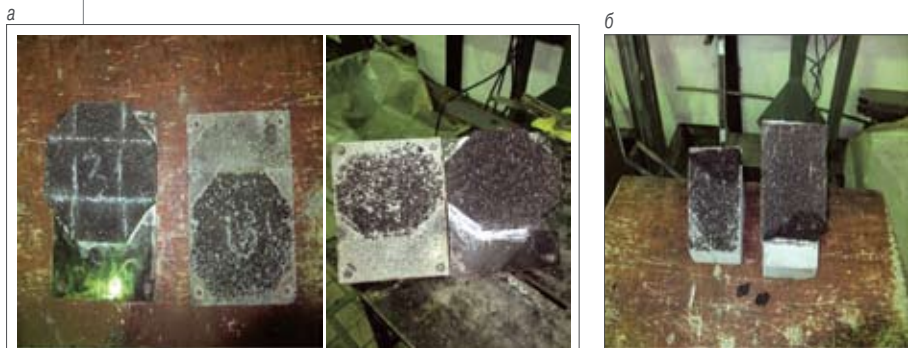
Плоскости сдвига по контакту гидроизоляции с литым асфальтом: а – металлическое основание; б – бетонное основание
